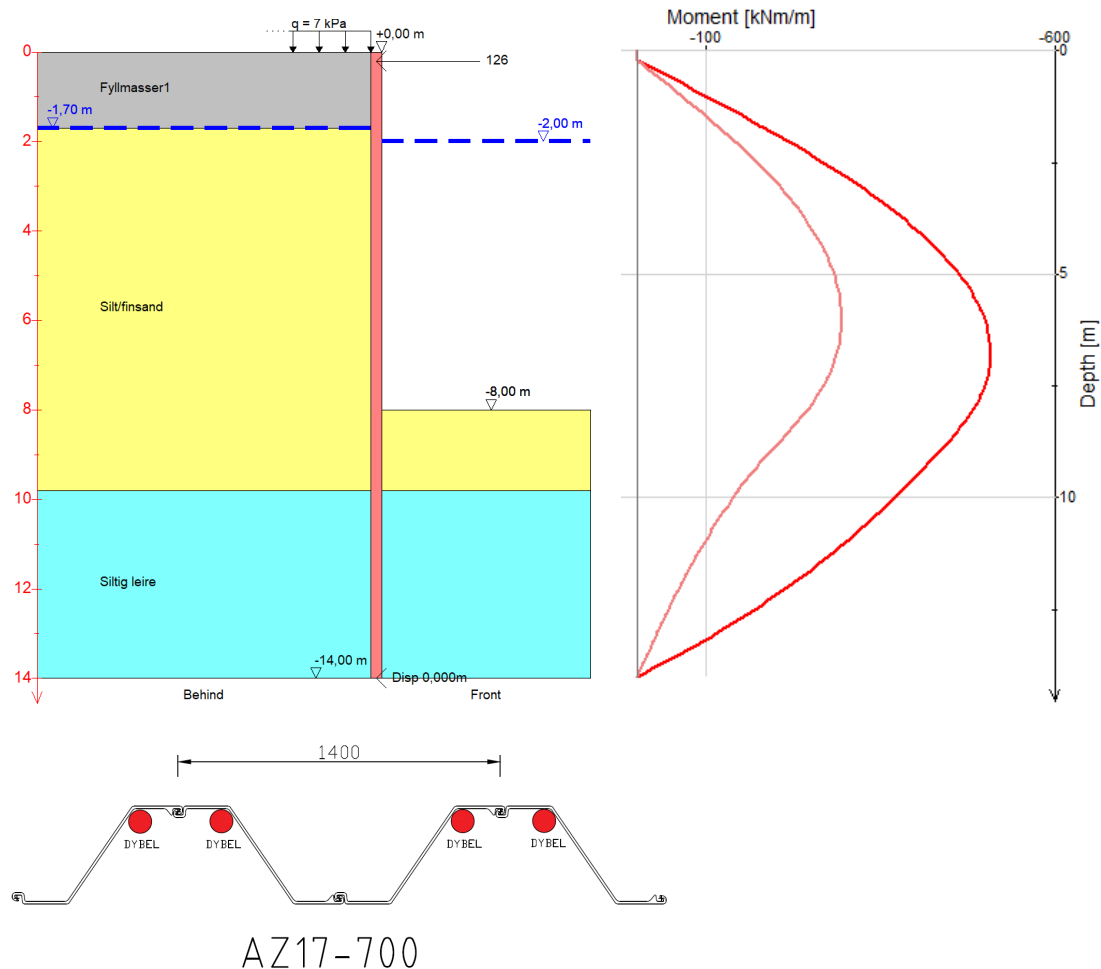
Skissering av planlagt kaikonstruksjon/spunt
